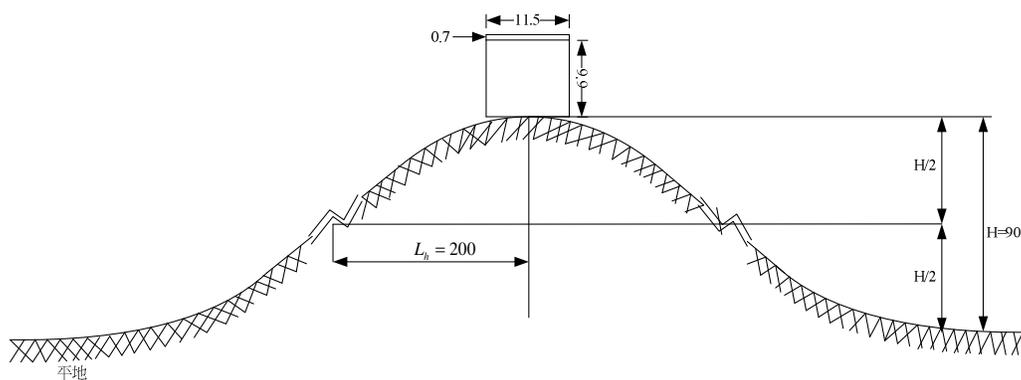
低層建築物東西向與附近地形立面示意圖 單位 (m)
